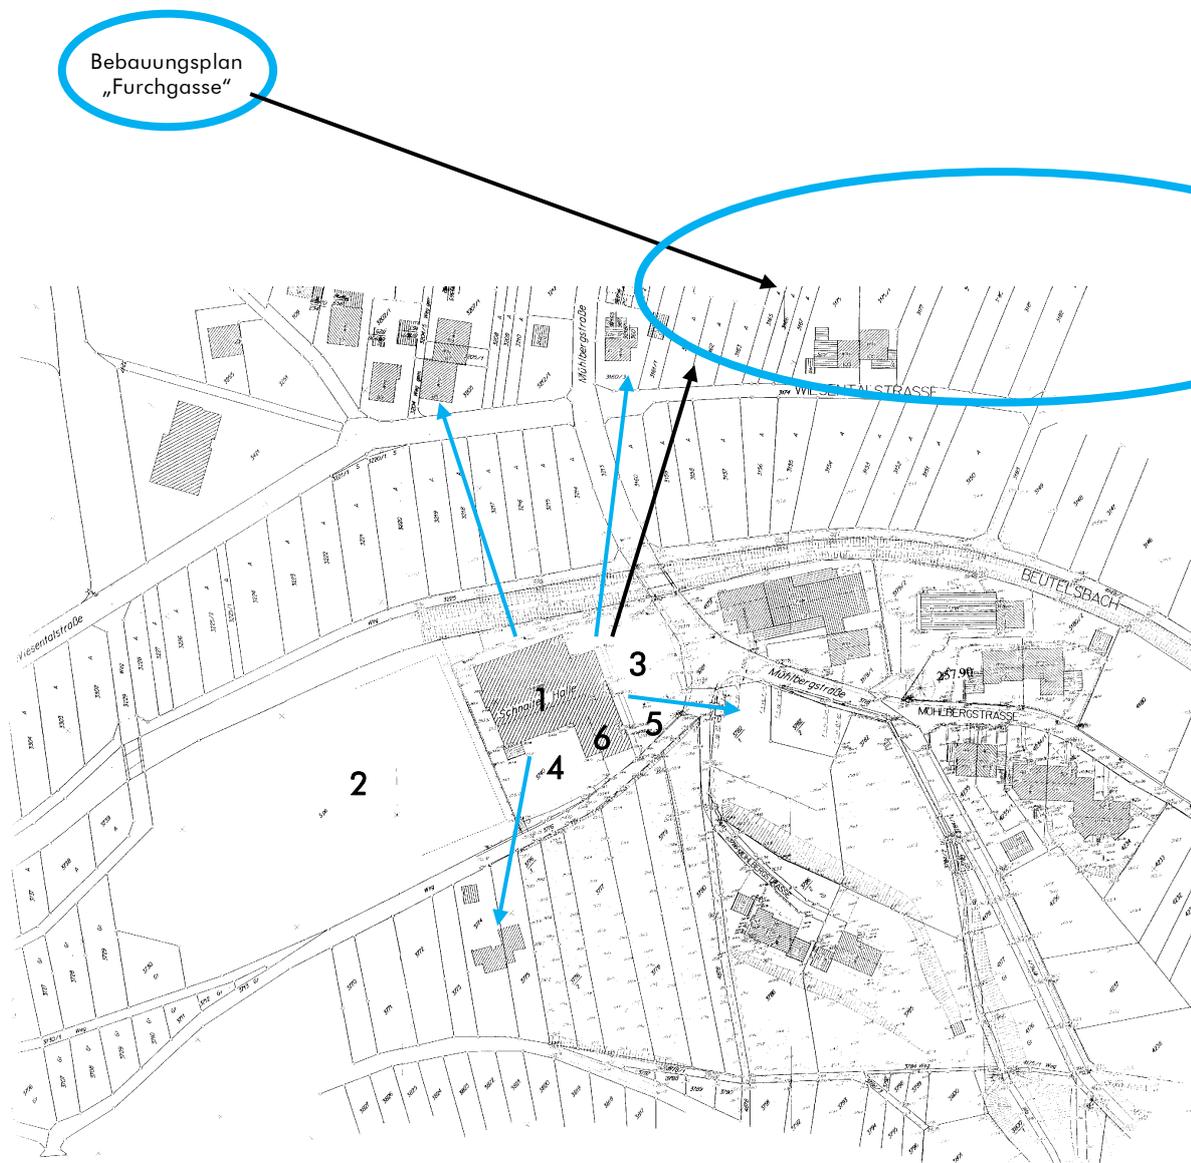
Lageplan im Bereich Schnaiter Halle und Kennzeichnung der Nutzungen im Bereich der Schnaiter Halle, nicht maßstäblich
